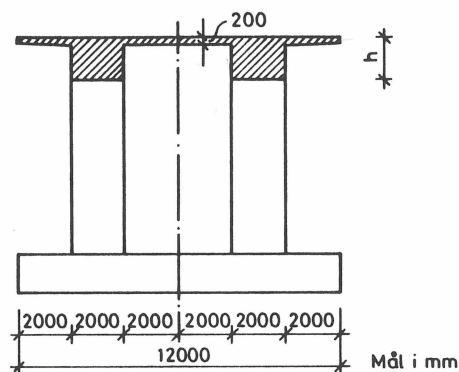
Beton 50, træk- og trykarmering T 550.
